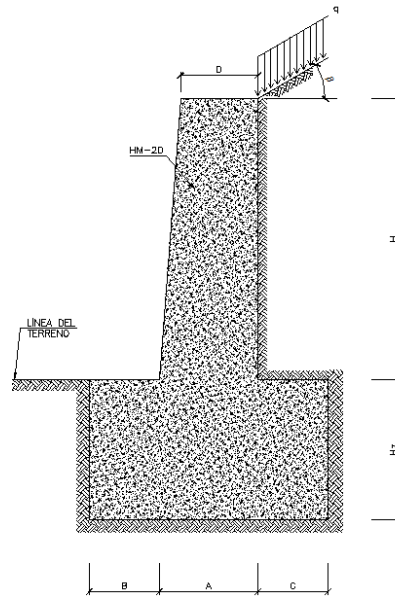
Dimensiones de muro tipo de hormigón en masa. Fuente: Elaboración propia.
